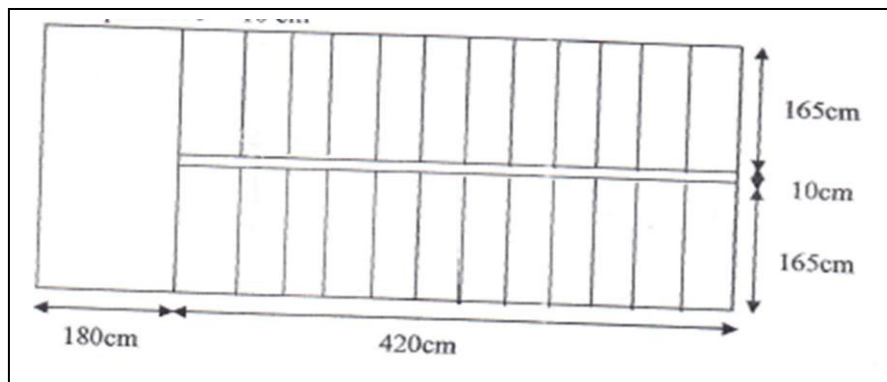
Vue en plan et coupe verticale d'escalier RDC
